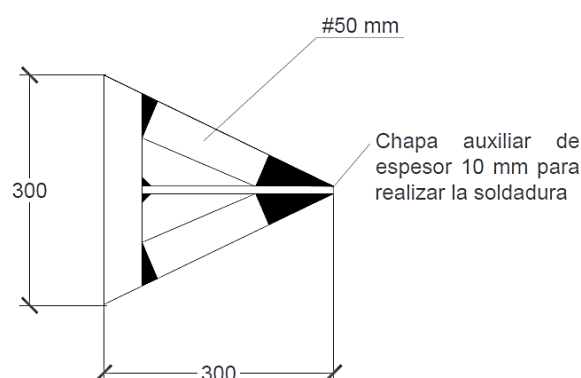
Sección transversal de las péndolas rígidas. Elaboración propia con AutoCAD
